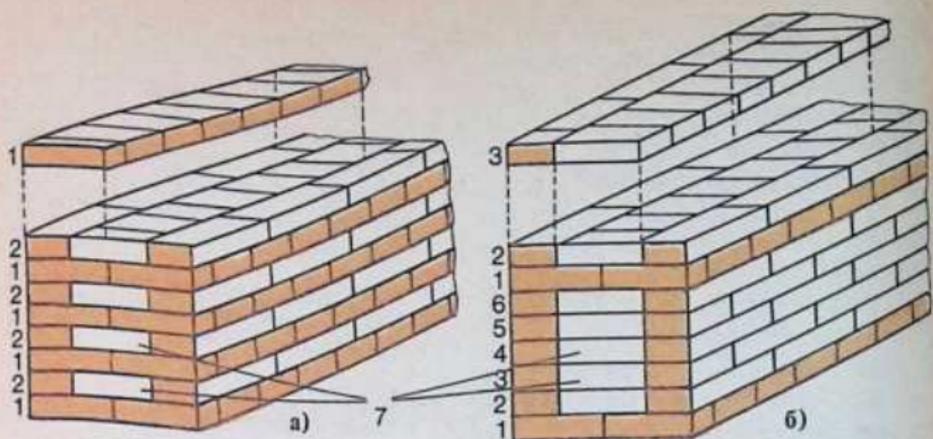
Системы перевязки при кладке стен толщиной 2 кирпича:
